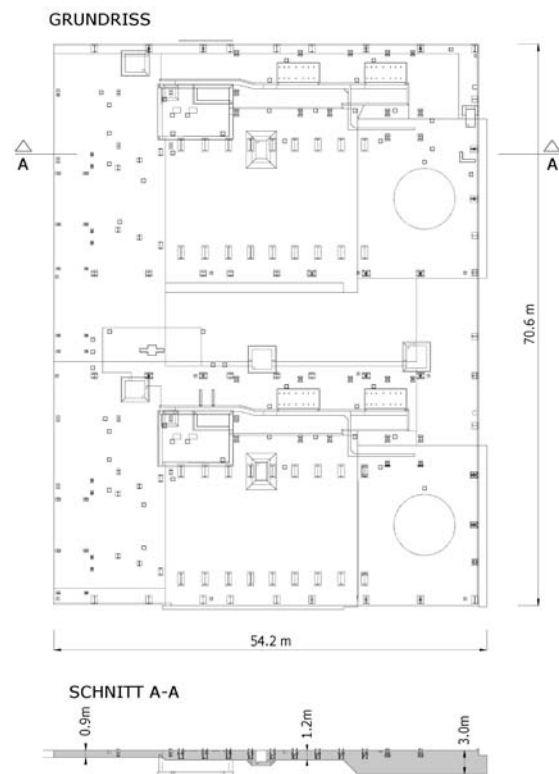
Kraftwerk, Fundierung Abhitzeessel und Kamin (Grundriss und Schnitt)
